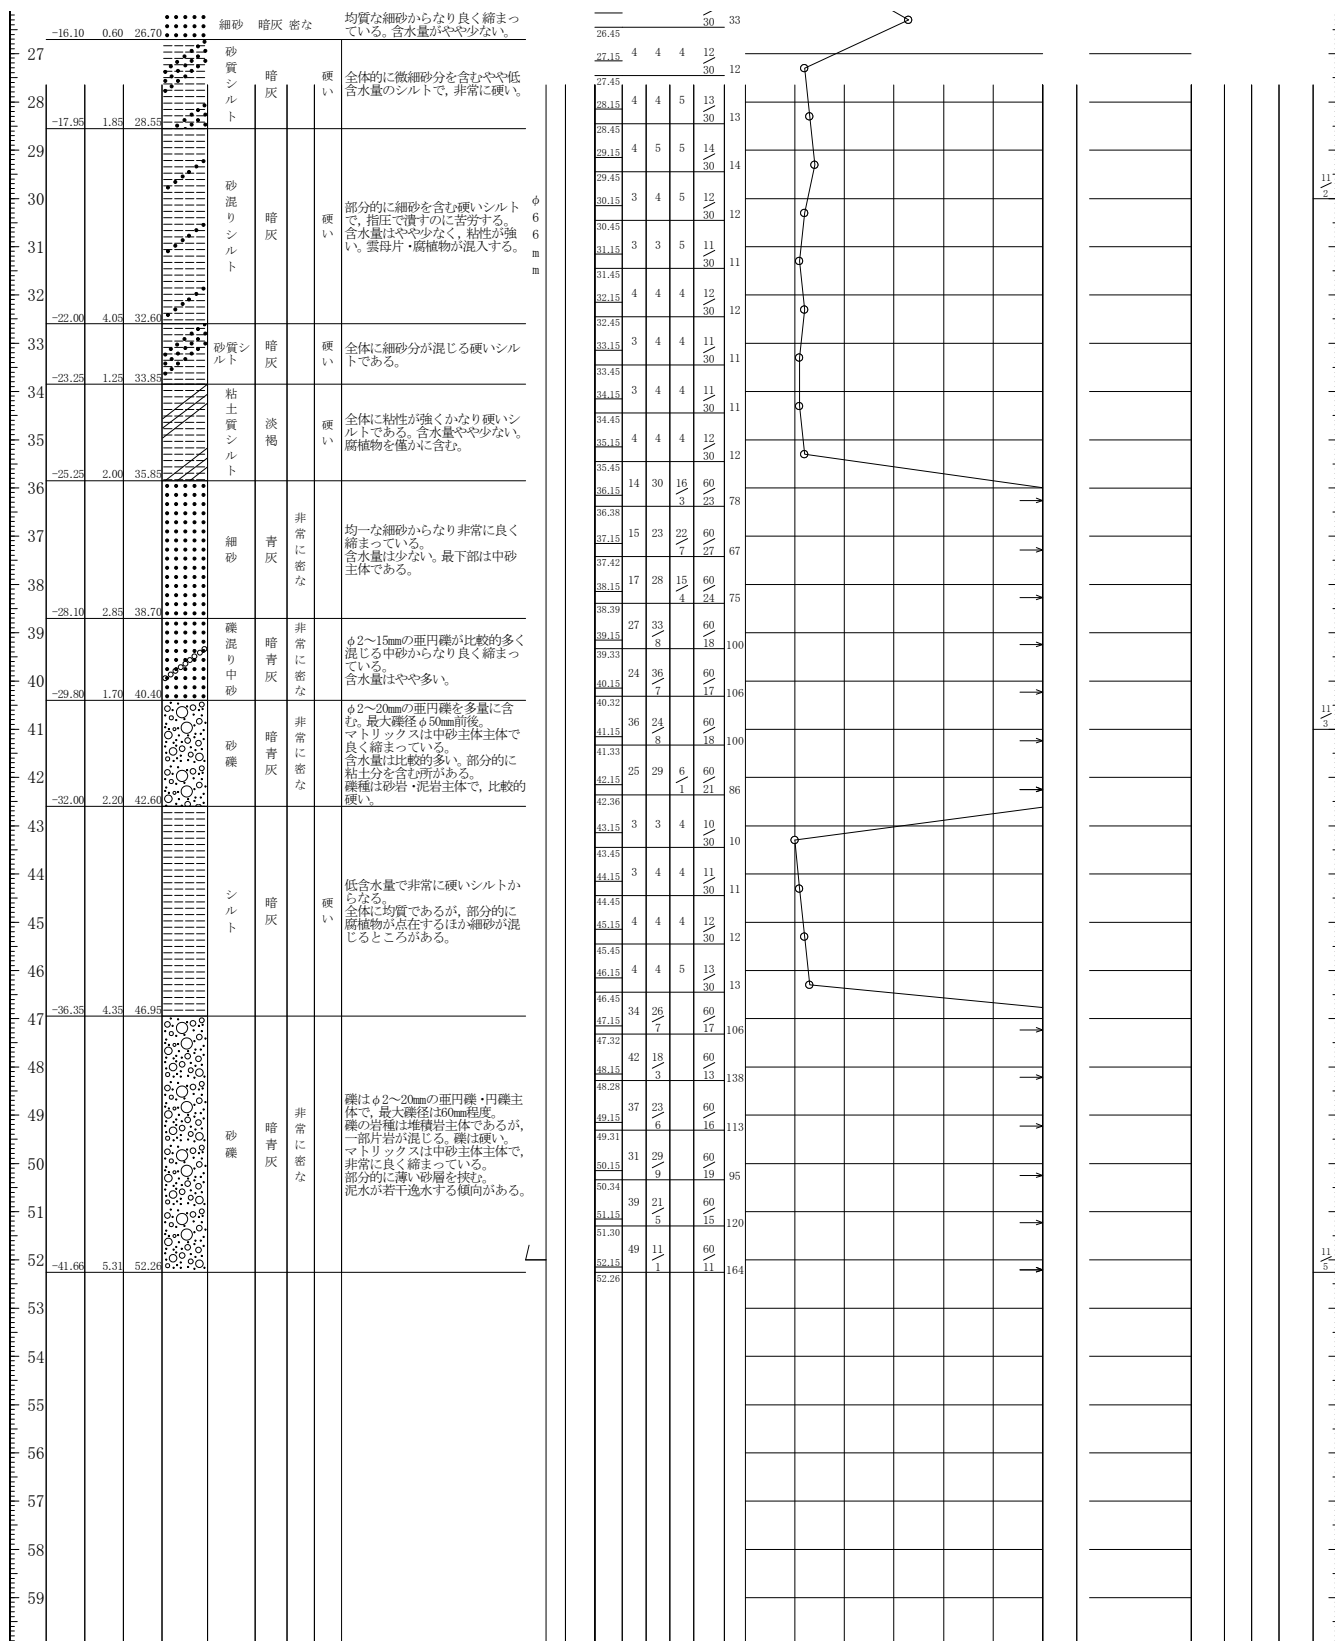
(1) ボーリング柱状図 (No.4-1)
